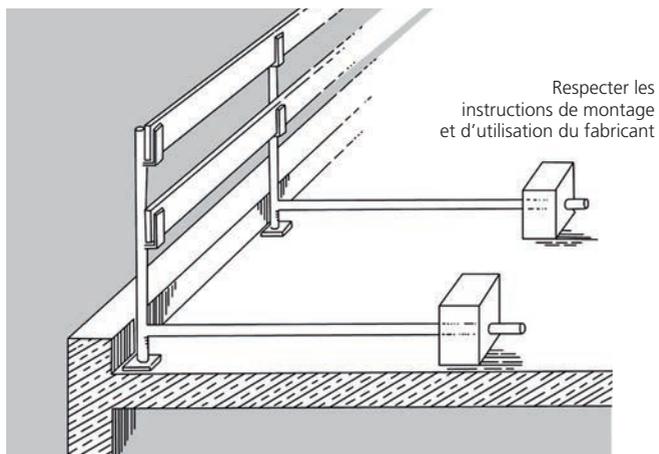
Exemple de protection latérale au niveau de l'avant-toit (pignon)
